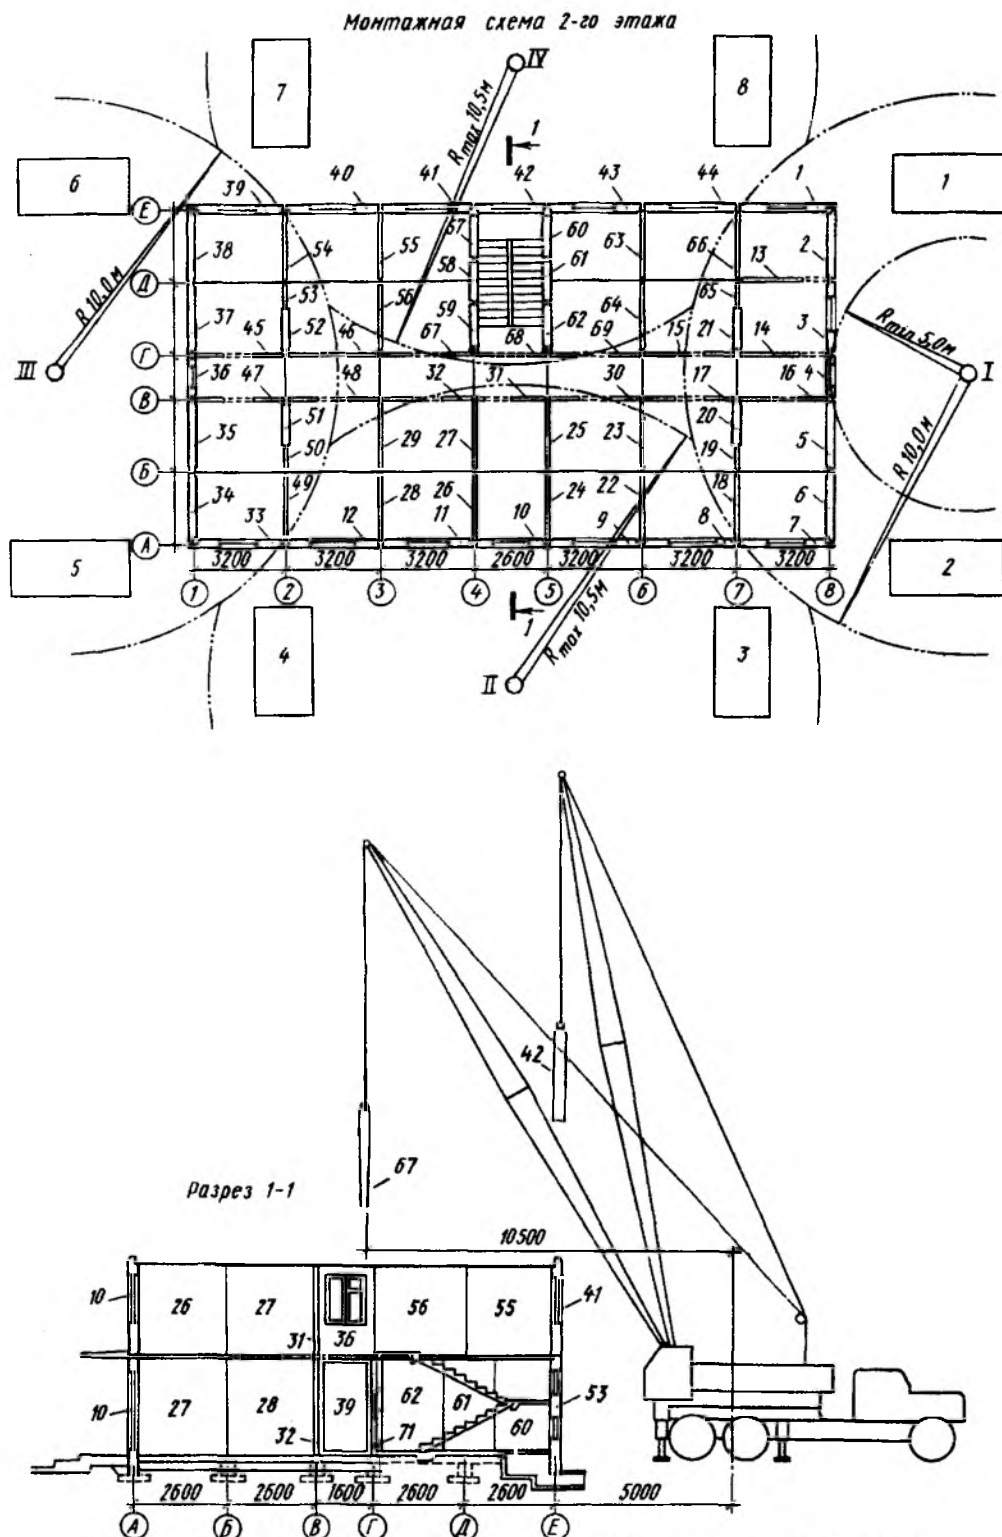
Схема монтажа стеновых панелей второго этажа здания общежития
